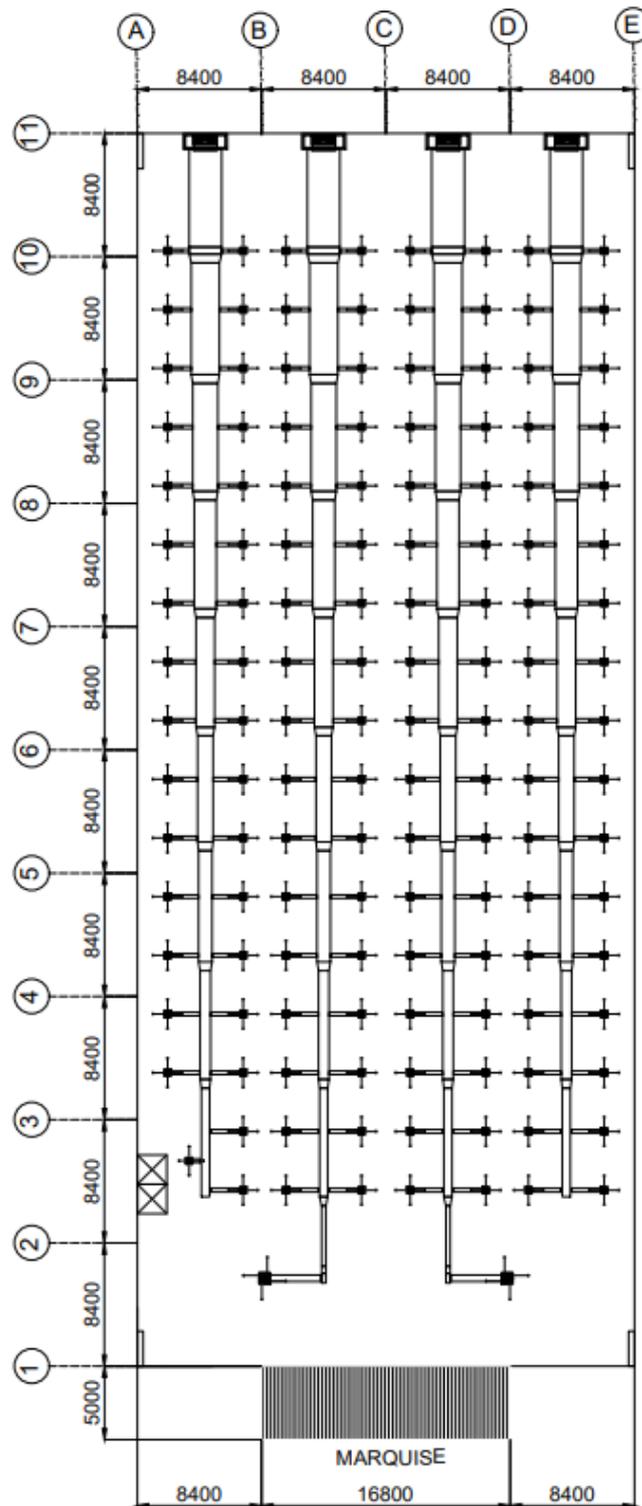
Planta da cobertura, mostrando a tubulação do ar-condicionado (medidas em mm).
